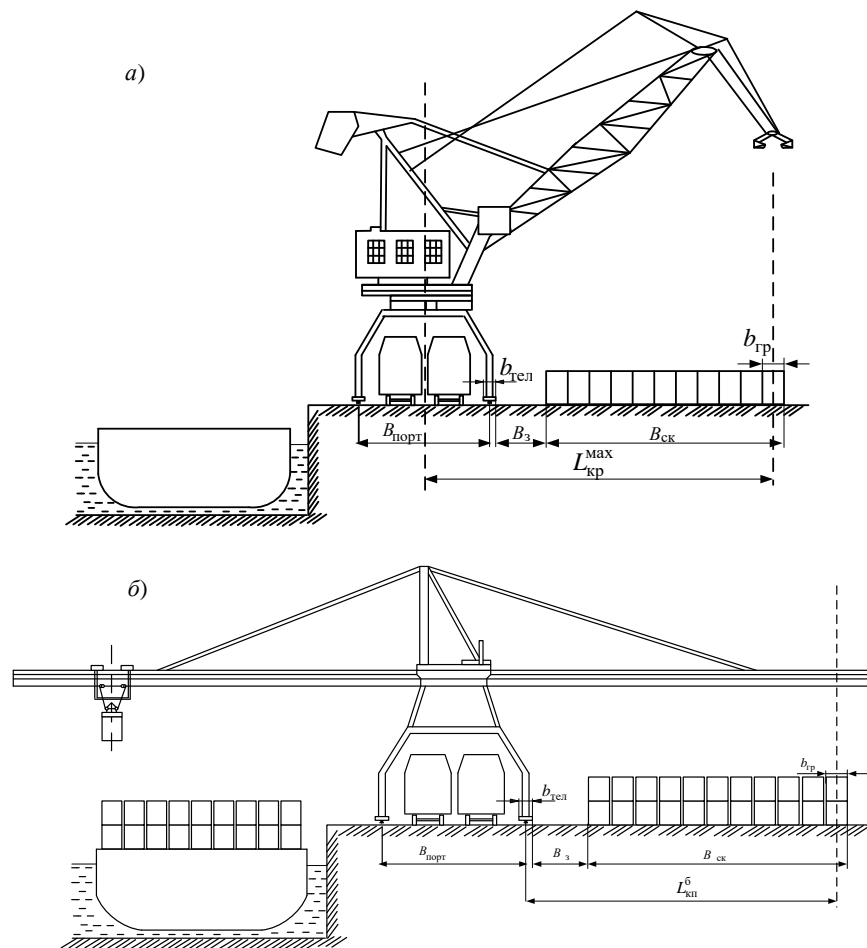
Расчетные схемы определения $B_{ск}$ при использовании портального крана (а) и контейнероперегрузчика (б)
